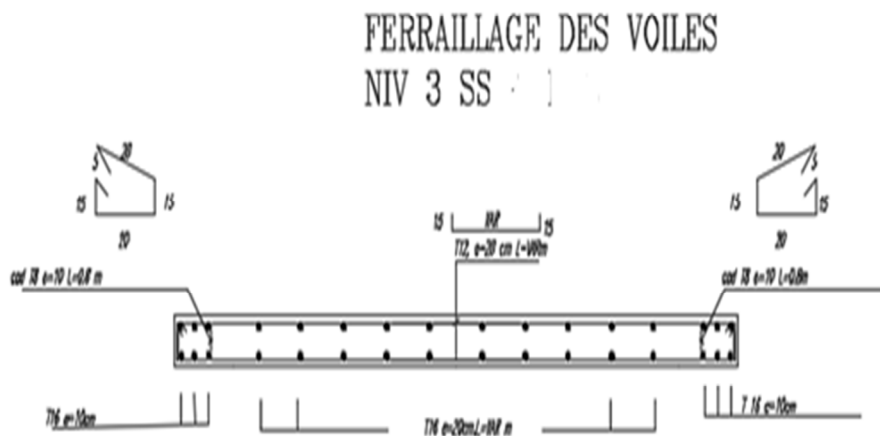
ferrailage des voiles au niveau de s/sol
